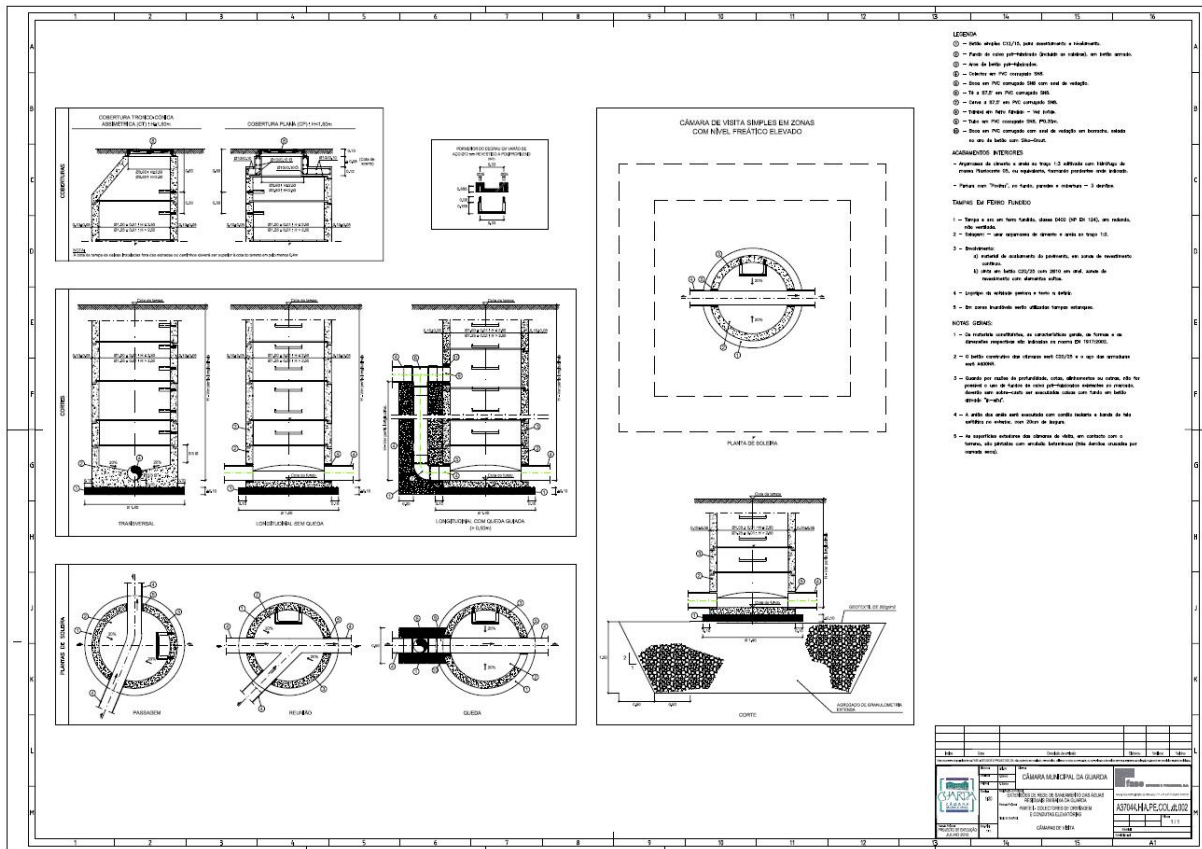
Layout de um pormenor tipo de câmara de visita. (Fonte: FASE)
